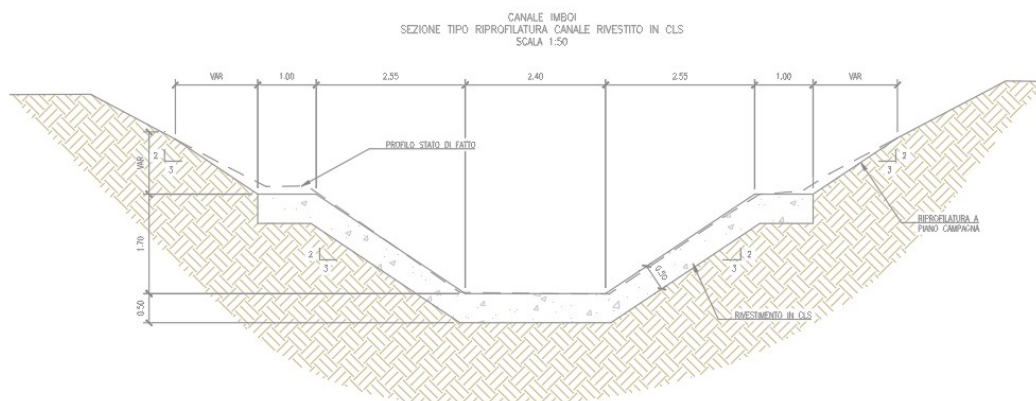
Sezione tipo canale Imboi (tratto rivestito)
